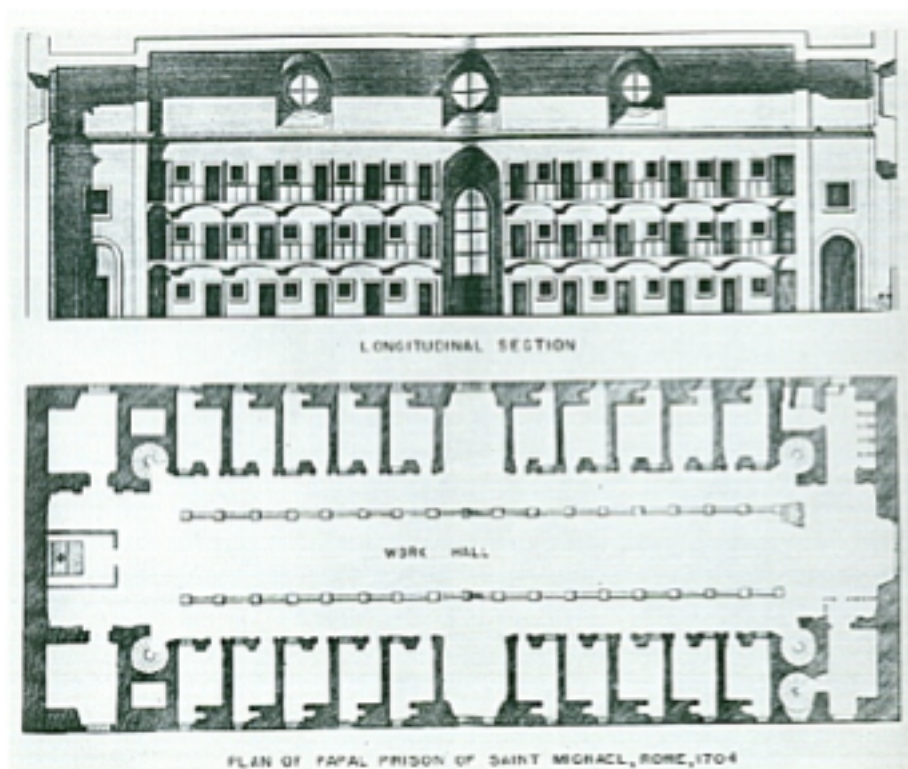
Planta y alzado del Hospicio de San Miguel.
